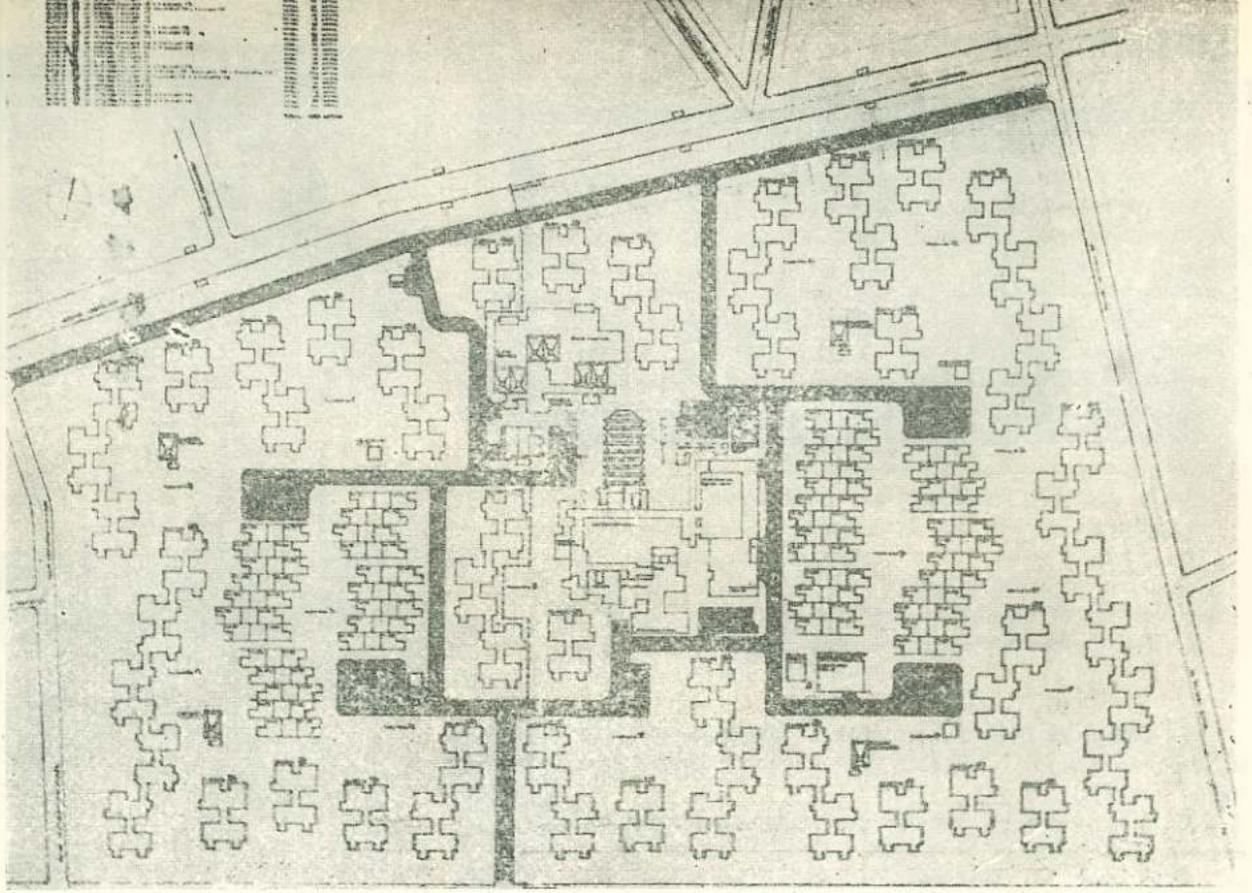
Cooperativa "CIVIS" (13 unidades). Planta baja. Calle Rafael Pastoriza 1451. Montevideo. En construcción. Centro Cooperativista Uruguayo.
